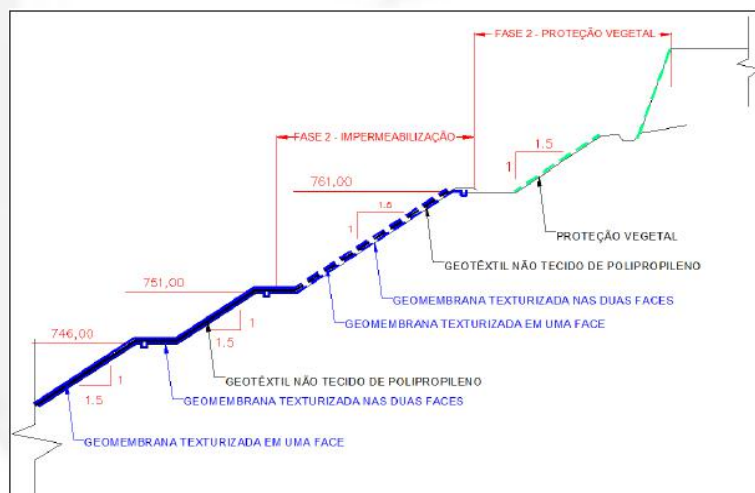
Sistema de impermeabilização entre as elevações 751 m e 761 m. Fonte: PA 74/1980/087/2017
